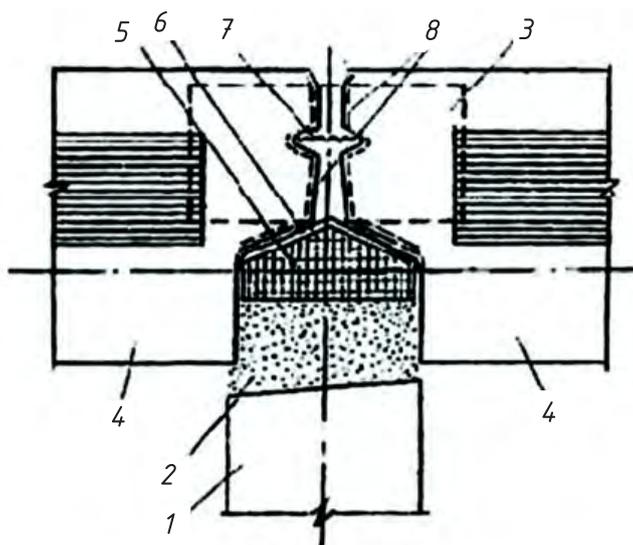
Заделка вертикального открытого стыка: 1 — панель внутренней стены; 2 — цементный раствор; 3 — слив из алюминия в местах пересечения вертикальных и горизонтальных стыков; 4 — панели наружной стены; 5 — утепляющий вкладыш; 6 — воздухозащитная лента на клею; 7 — водоотбойная лента; 8 — покрытие грунтовоочным составом
